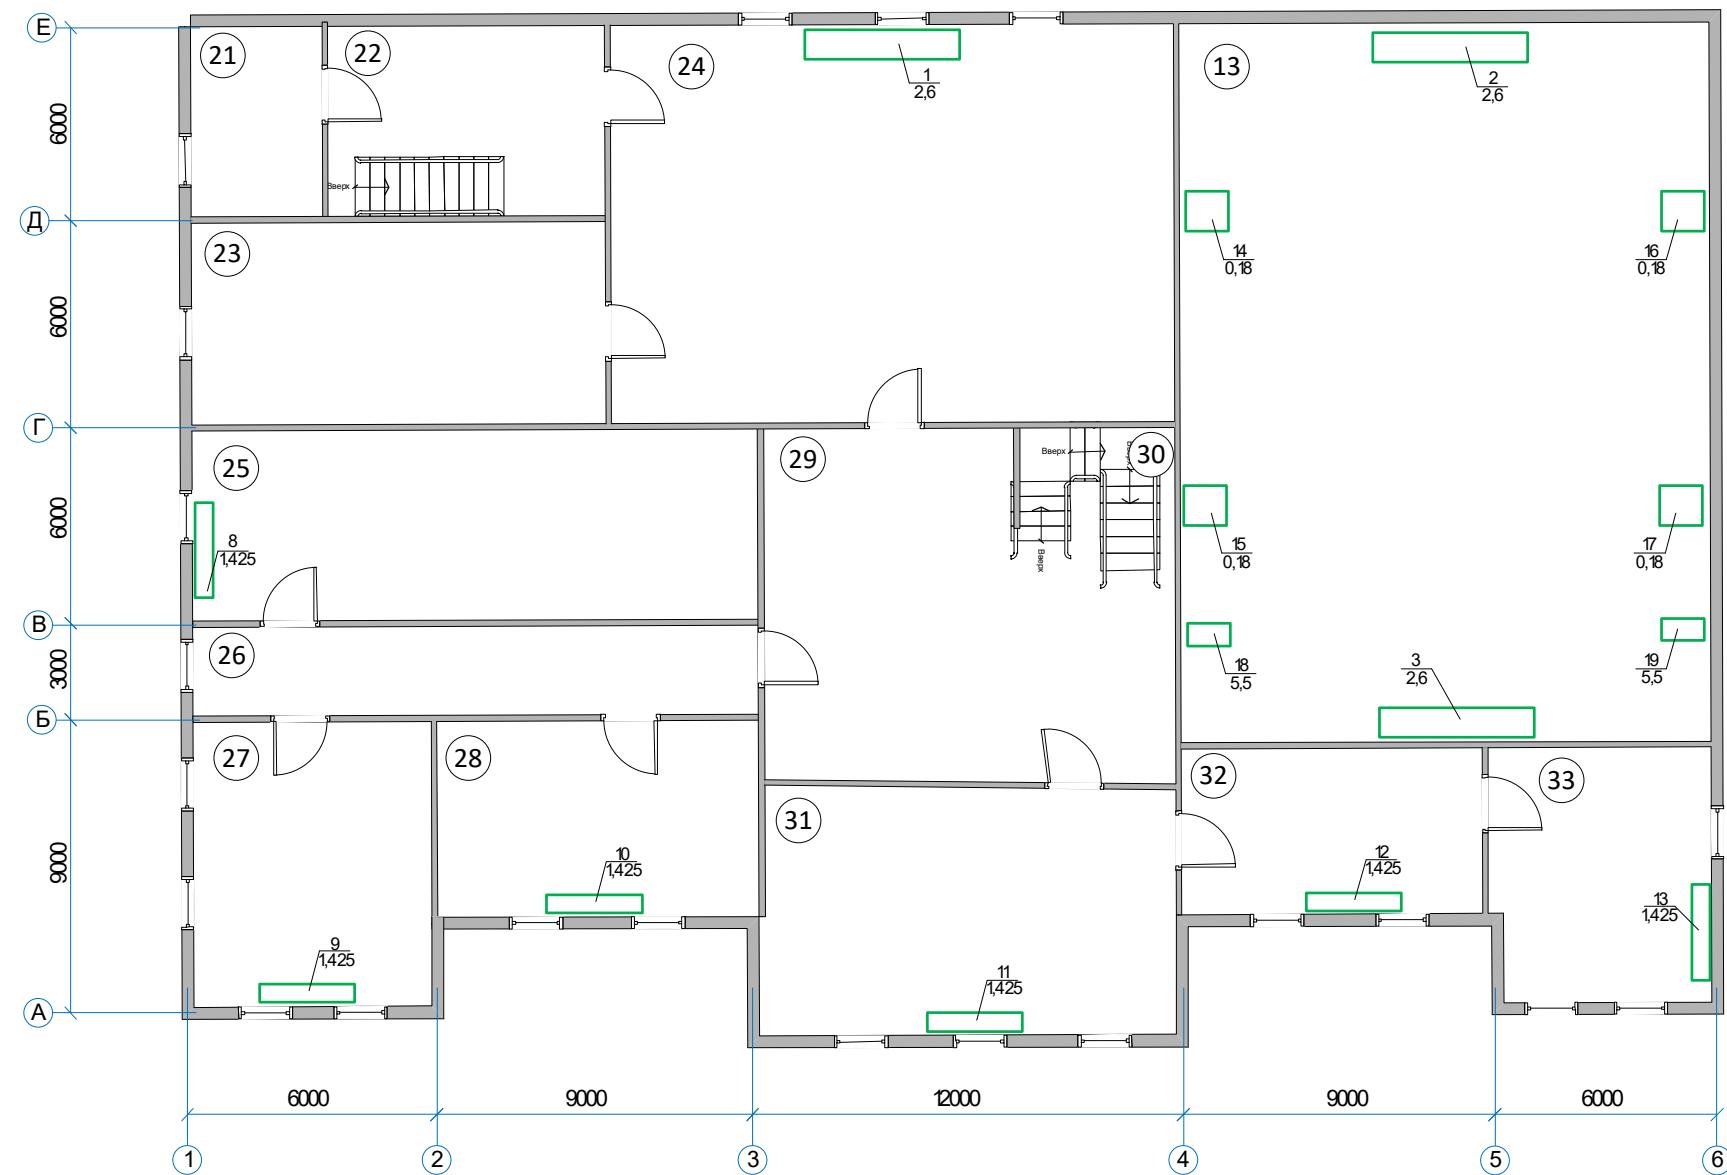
План расстановки электрооборудования на 2-м этаже
